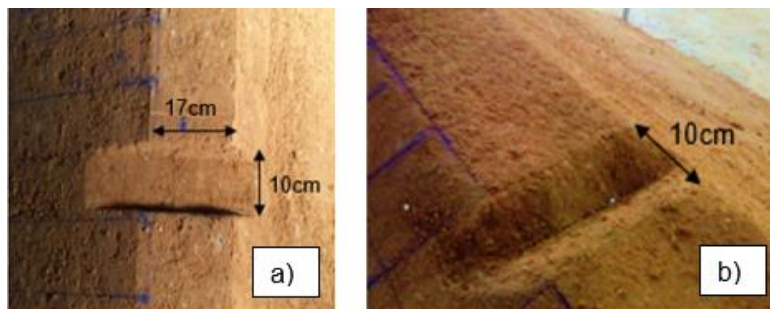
Canais piloto dos ensaios realizados a) Ensaio 2 - geometria retangular; b) Ensaio 1 e 3 (*Kinect Sensor*) – geometria triangular.
